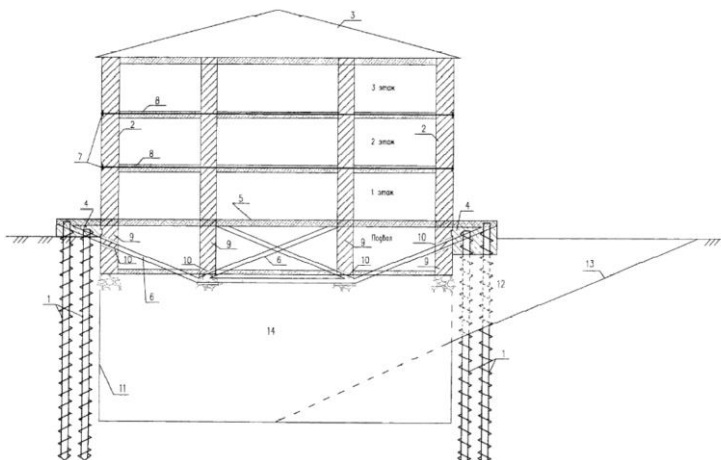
Разрез конструкции подземного сооружения под реконструируемым зданием фракций: 1 – ряд свай; 2 – наружные стены здания; 3 – здание; 4 – ростверк; 5 – ж/б плита; 6 – стержни ферм; 7 – пояса усиления; 8 – перекрытия; 9 – стена подвала или цокольного этажа; 10 – отверстия для стержней ферм; 11 – объем подземного объекта; 12 – порталный проем; 13 – пандус; 14 – грунт
